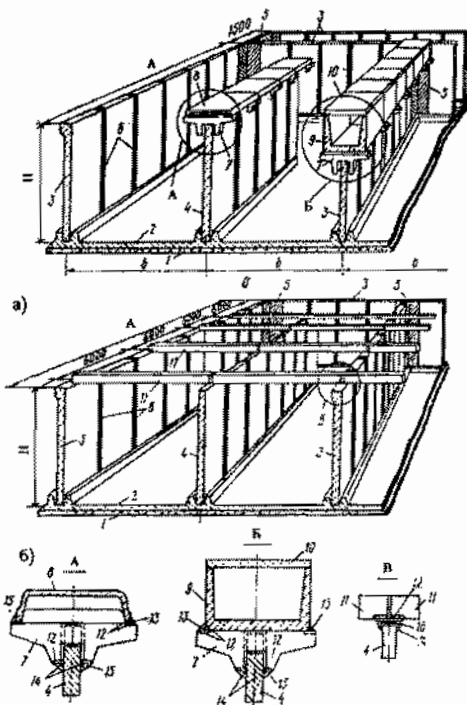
Детали раскладки и крепления сборных элементов мостиков, лотков и распорок в открытых прямоугольных емкостных сооружениях: а - емкостное сооружение из консольных стеновых панелей; б - то же, из балочных стеновых панелей; 1 - бетонная подготовка; 2 - монолитное днище с пазами для установки стеновых панелей; 3 - стеновые панели рядовые; 4 - перегородочные панели; 5 - монолитные участки стен; 6 - стыки между панелями; 7 - поддерживающий элемент; 8 - плита ИПП-9; 9 - лоток ЛТ-1; 10 - плита ПТ; 11 - распорка; 12 - закладные детали; 13 - сварной монтажный шов; 14 - стальные клинья, привариваемые после установки элемента к его закладным деталям; 15 - цементный раствор; 16 - швеллер
